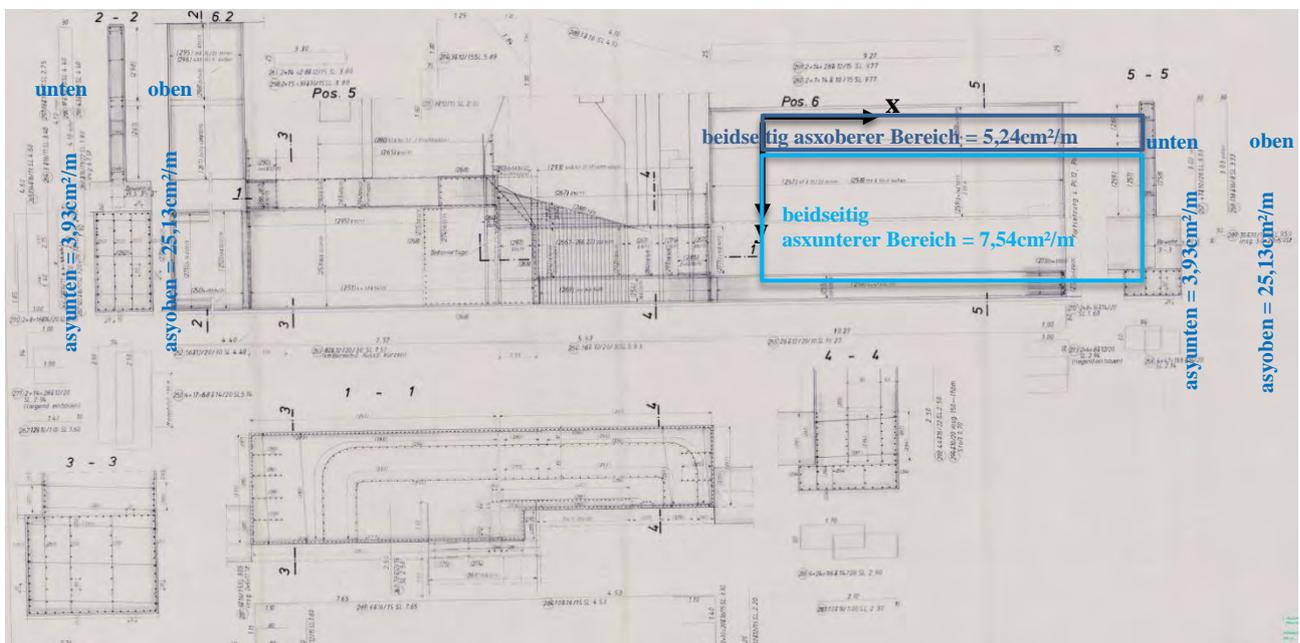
Vorhandene Biegebewehrung – POS 3: Balken für Nebenlager
